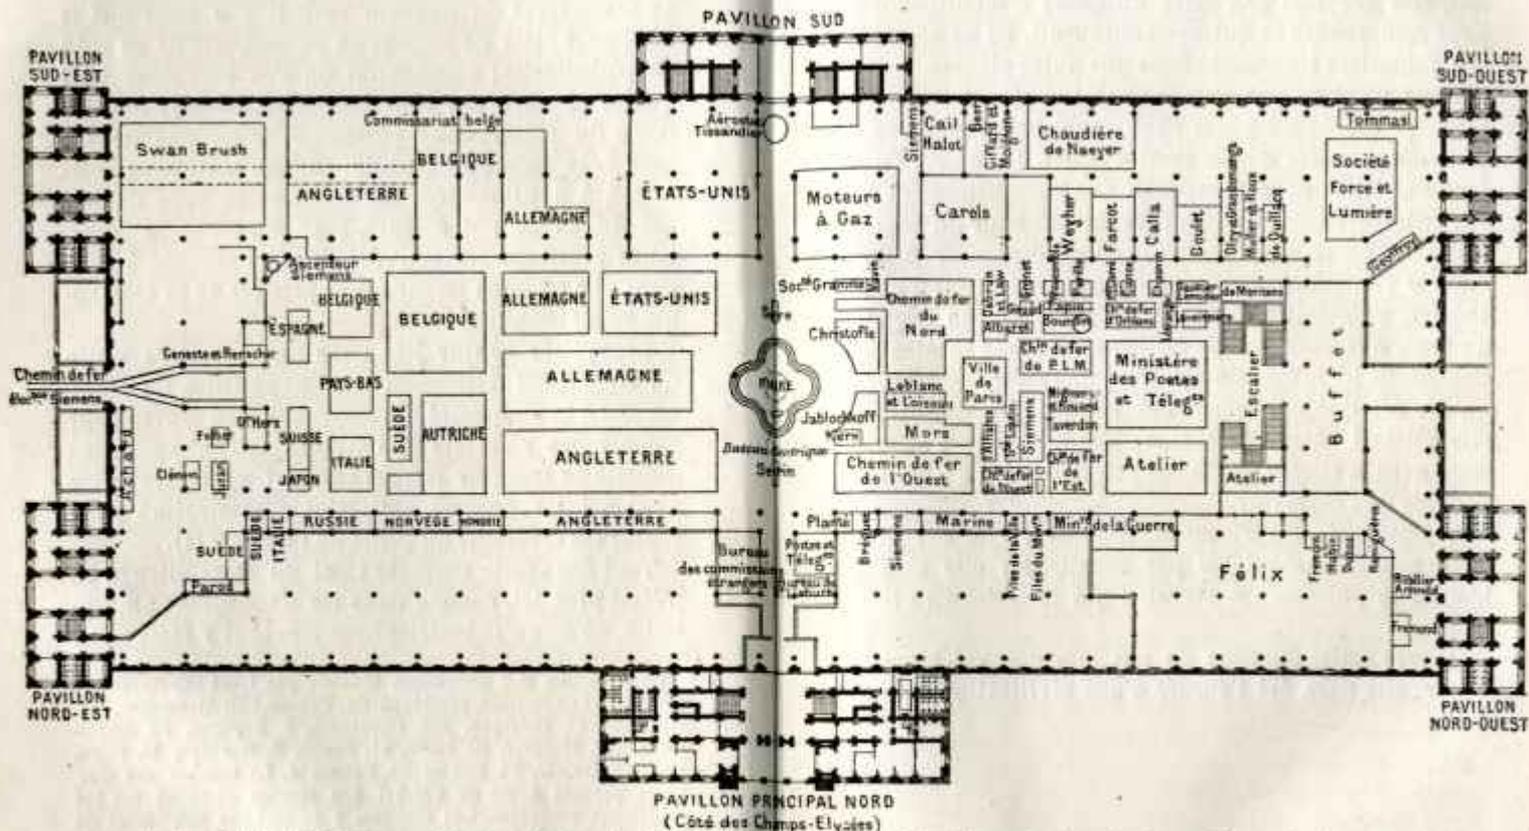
Palais de l'Industrie. — Plan du rez-de-chaussée de l'Exposition d'Électricité. — À droite la section française ; à gauche la section étrangère.
